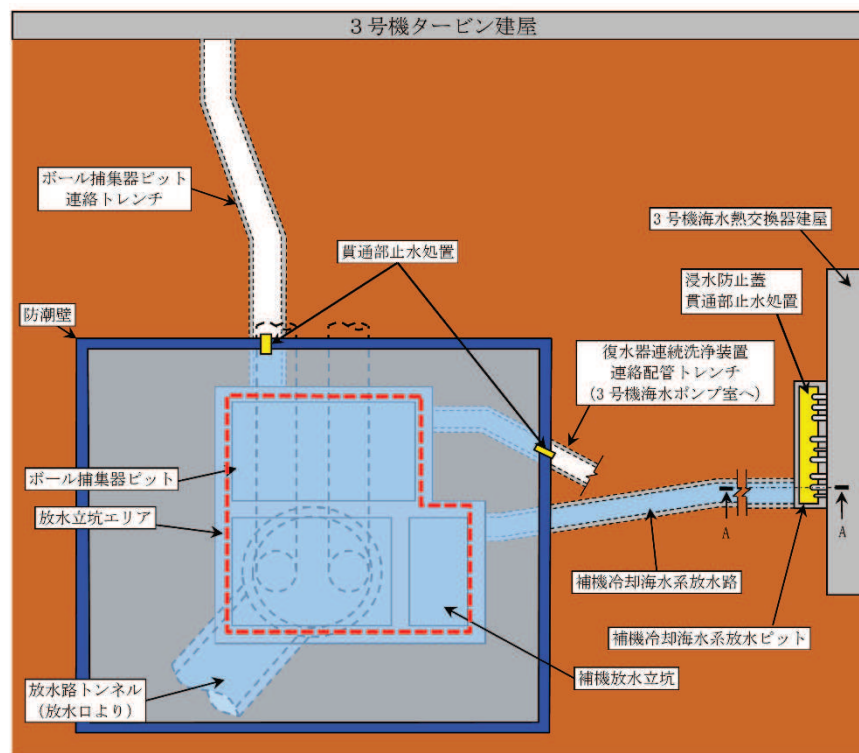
3号機 放水立坑 浸水対策配置図（平面図）
